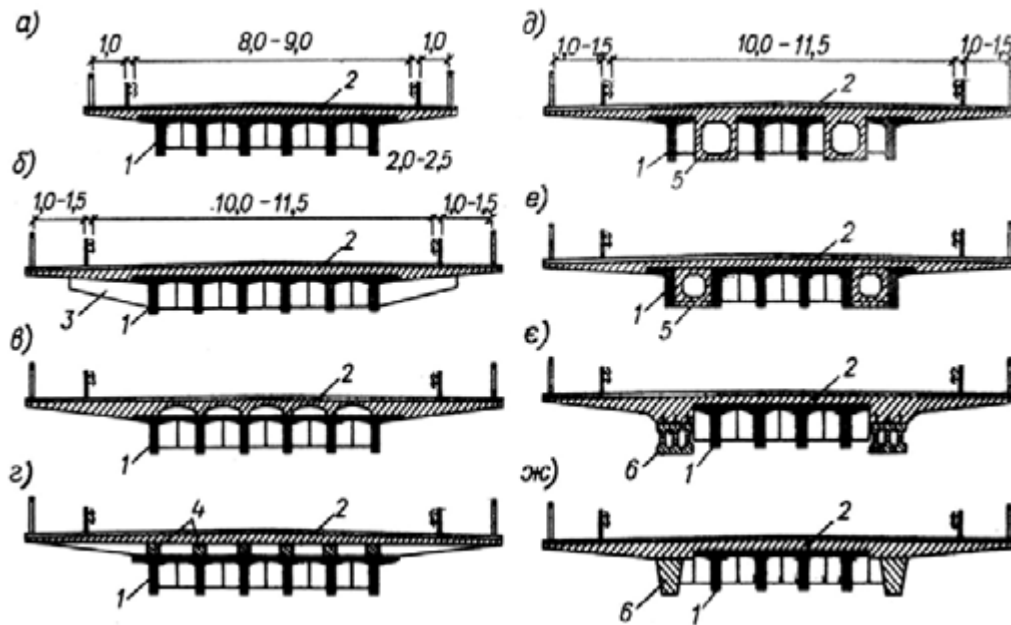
Розширення прольотних будов монолітною залізобетонною накладною плитою: а – плоскою плитою; б – з підкріпленням консолей поперечними ребрами; в – склепінчастою плитою; г – плитою з поздовжніми ребрами; д, е – із заміною балок або ділянок плити між суміжними балками; є, ж – із заміною крайніх балок; 1 – балки існуючої прольотної будови; 2 – накладна плита; 3 – поперечні ребра; 4 – збірні призматичні балки; 5 – нові коробчаті елементи; 6 – нові збірні елементи
